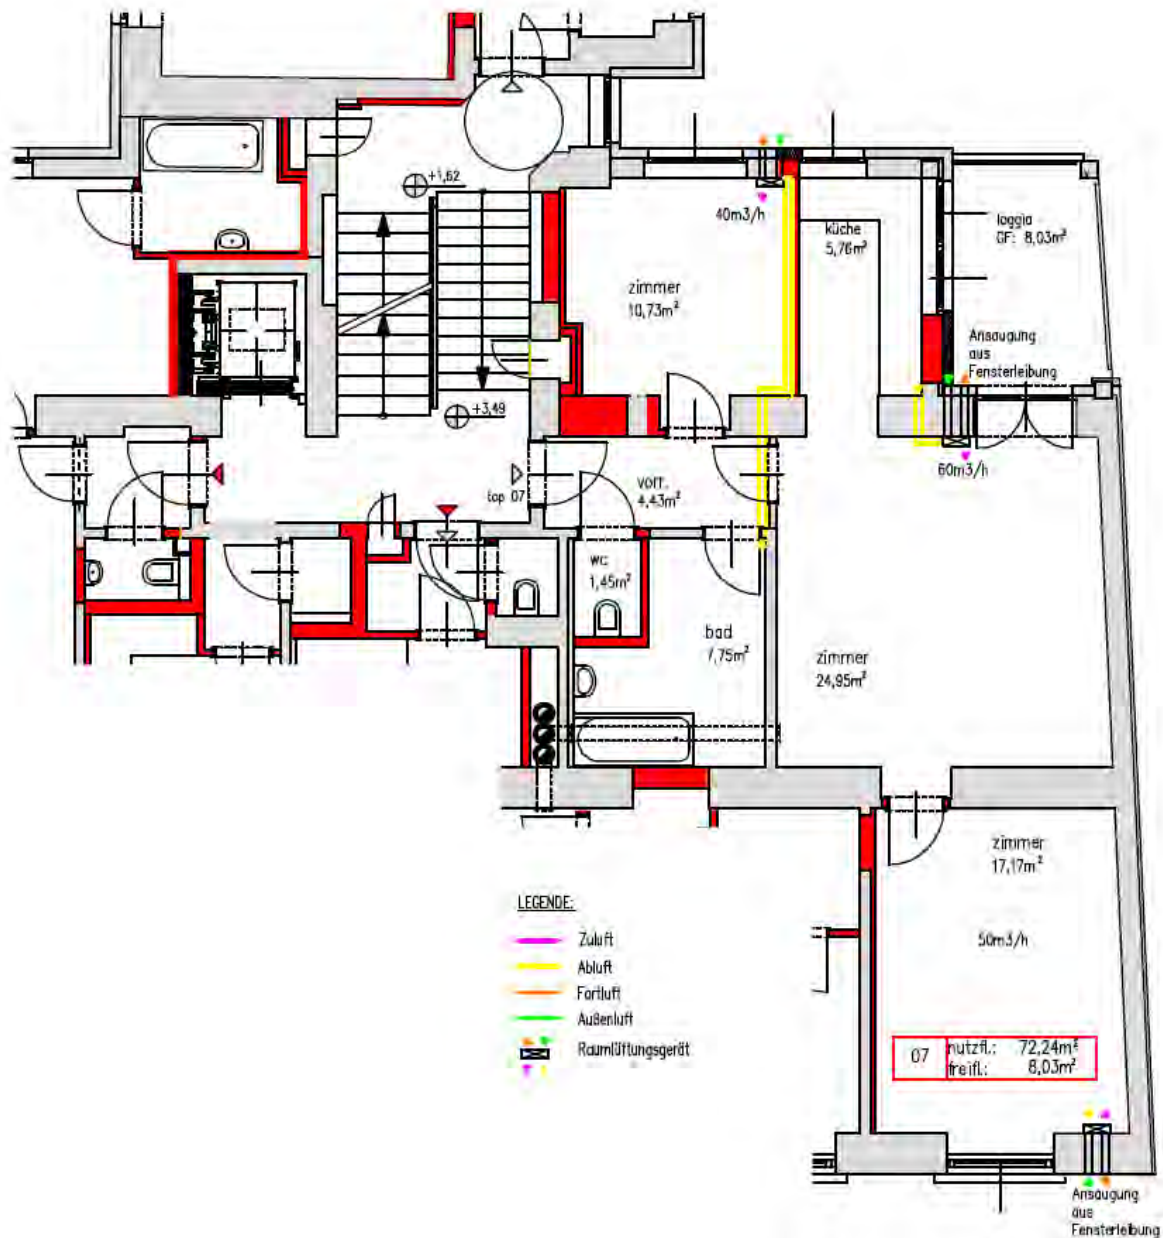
Grundrissdarstellung Raumlüftungsgeräte
